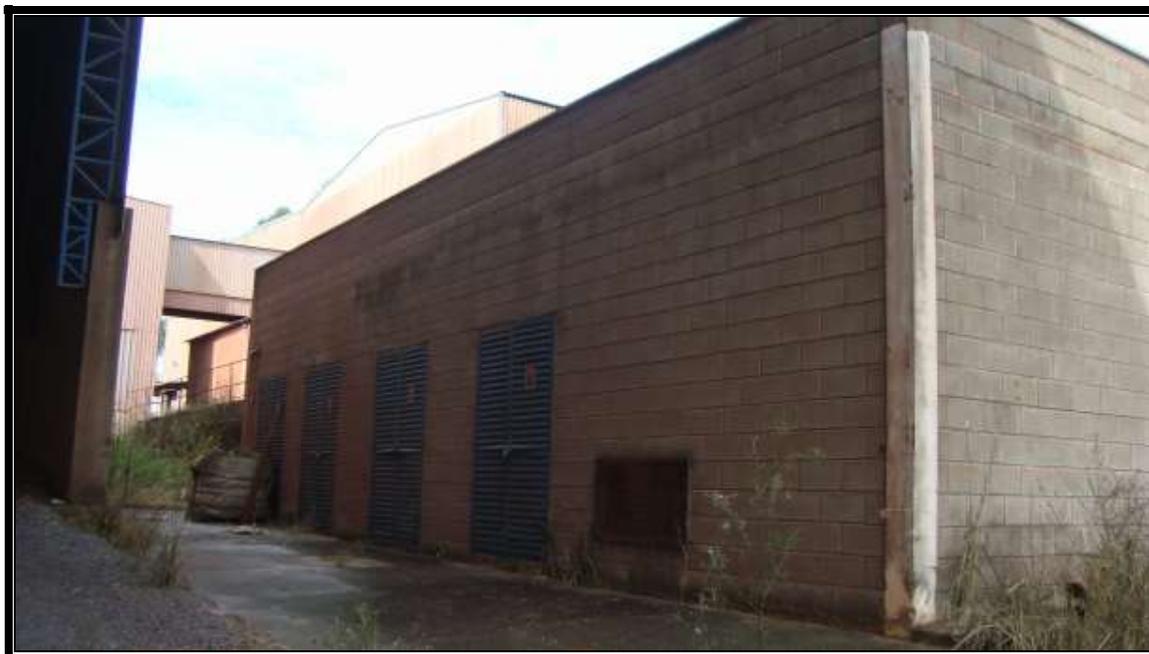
Vista do prédio da cabina de energia elétrica, construída em blocos de concreto.
